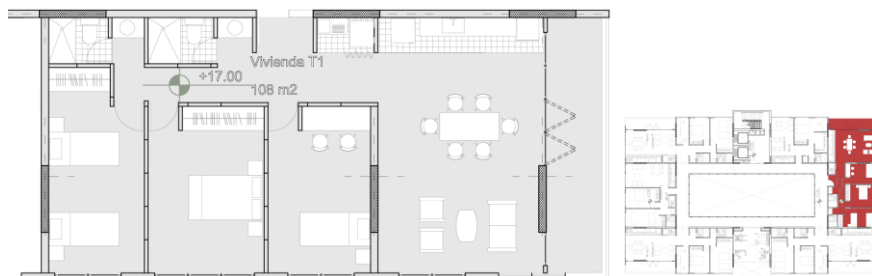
Planta Tipológica 1 (Jordan Baldassari, 2018)
